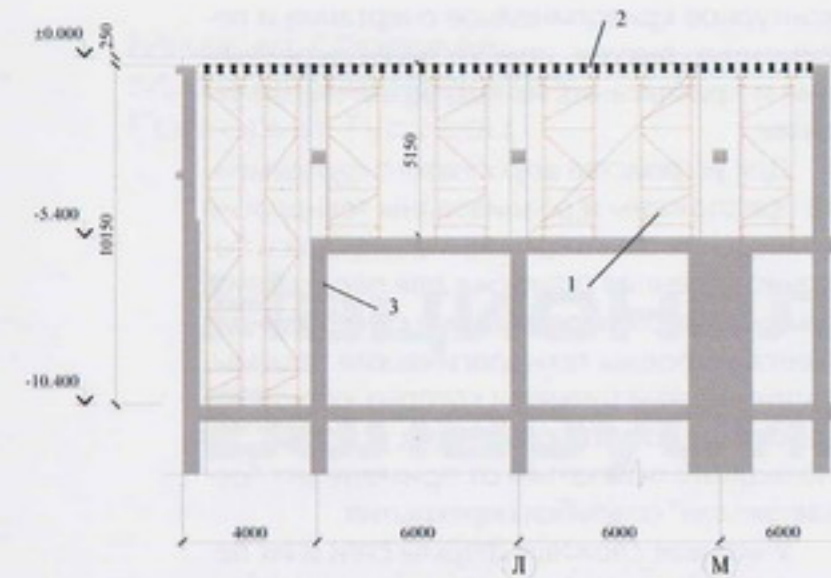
Схема опалубки монолитного перекрытия на отм. ±0,000:
